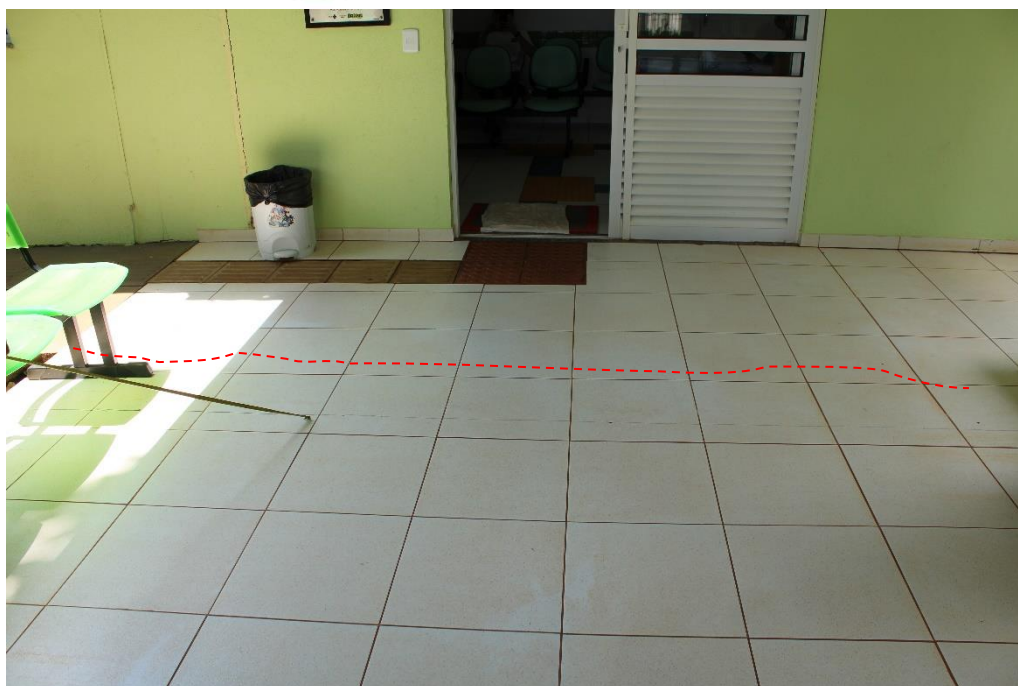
Vista da área coberta, supra qualificada, destacando fissura em revestimento cerâmico (piso).
